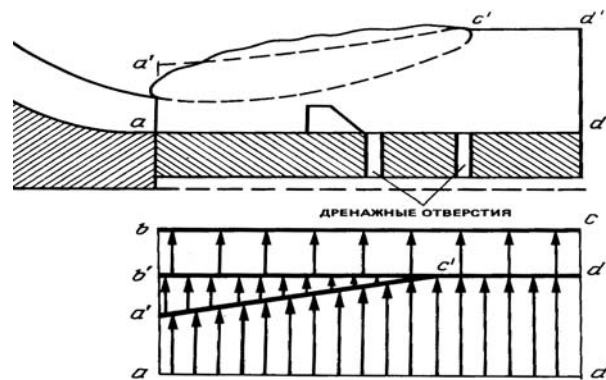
Схема к расчету нагрузок на плиту водобоя
